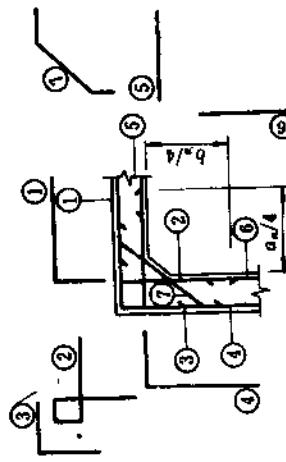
仓下支承柱不伸到仓顶的仓壁水平钢筋配置示意图
